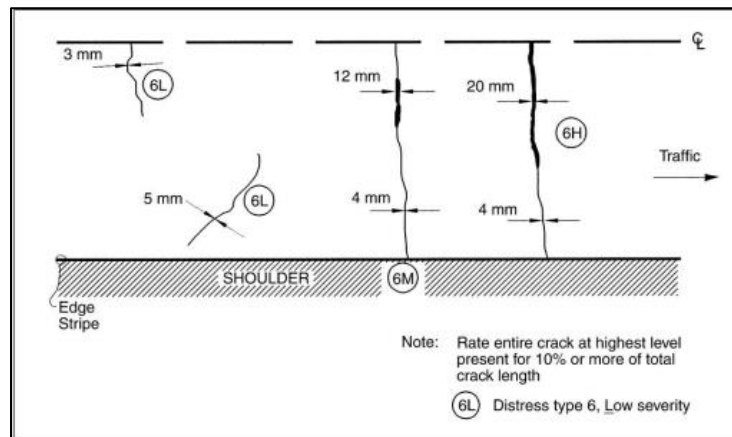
Diagrama nivel de gravedad para fisura transversal
